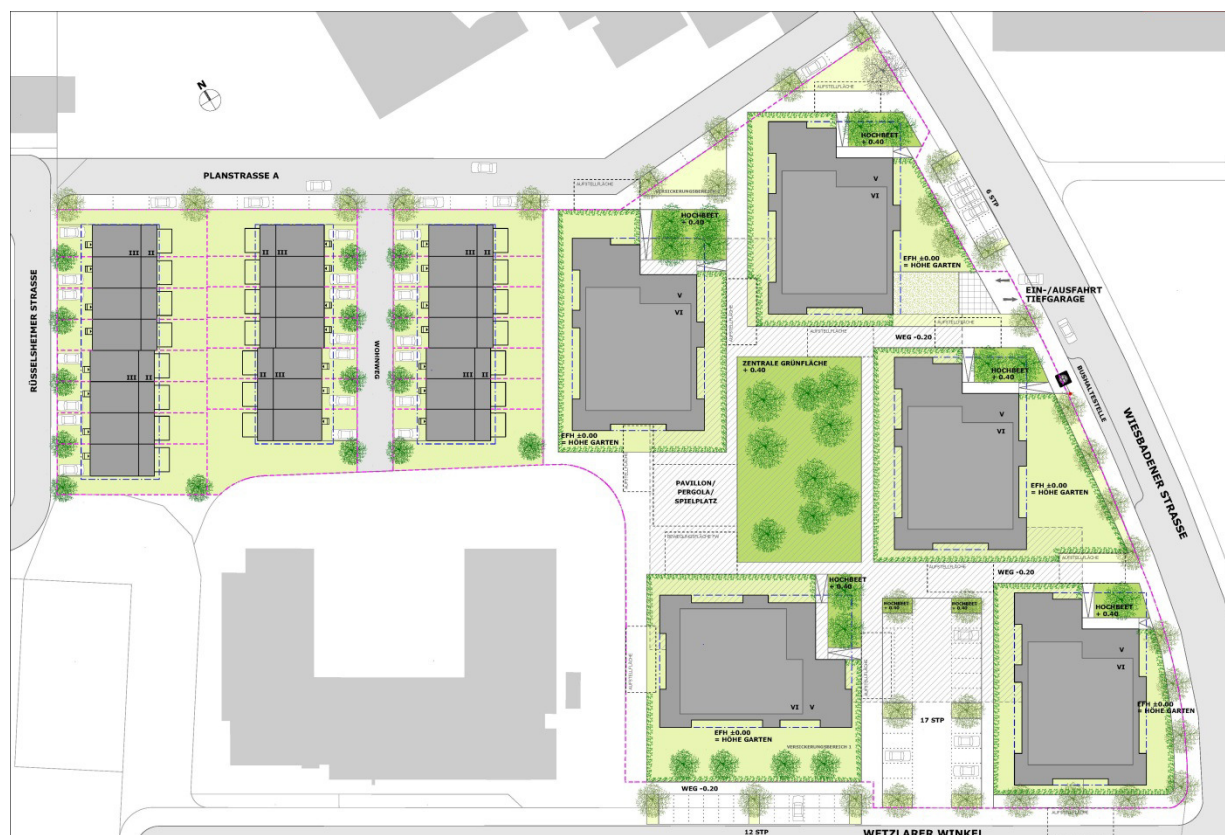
Städtebaulicher Rahmenplan (Stand: 03.06.2014)
